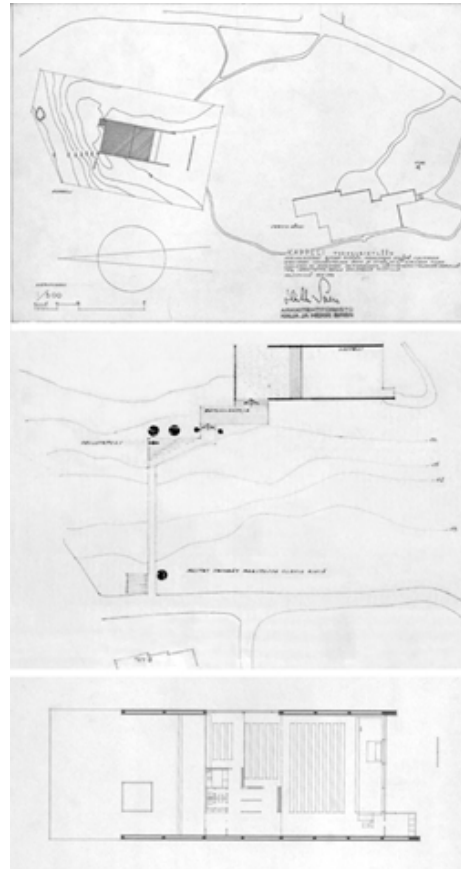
Kaija y Heikki Siren, Capilla de Otaniemi: plano de situación (29/10/1956) / sección longitudinal (1956) / planta del proyecto de reconstrucción de la capilla, tras el incendio (1977)
